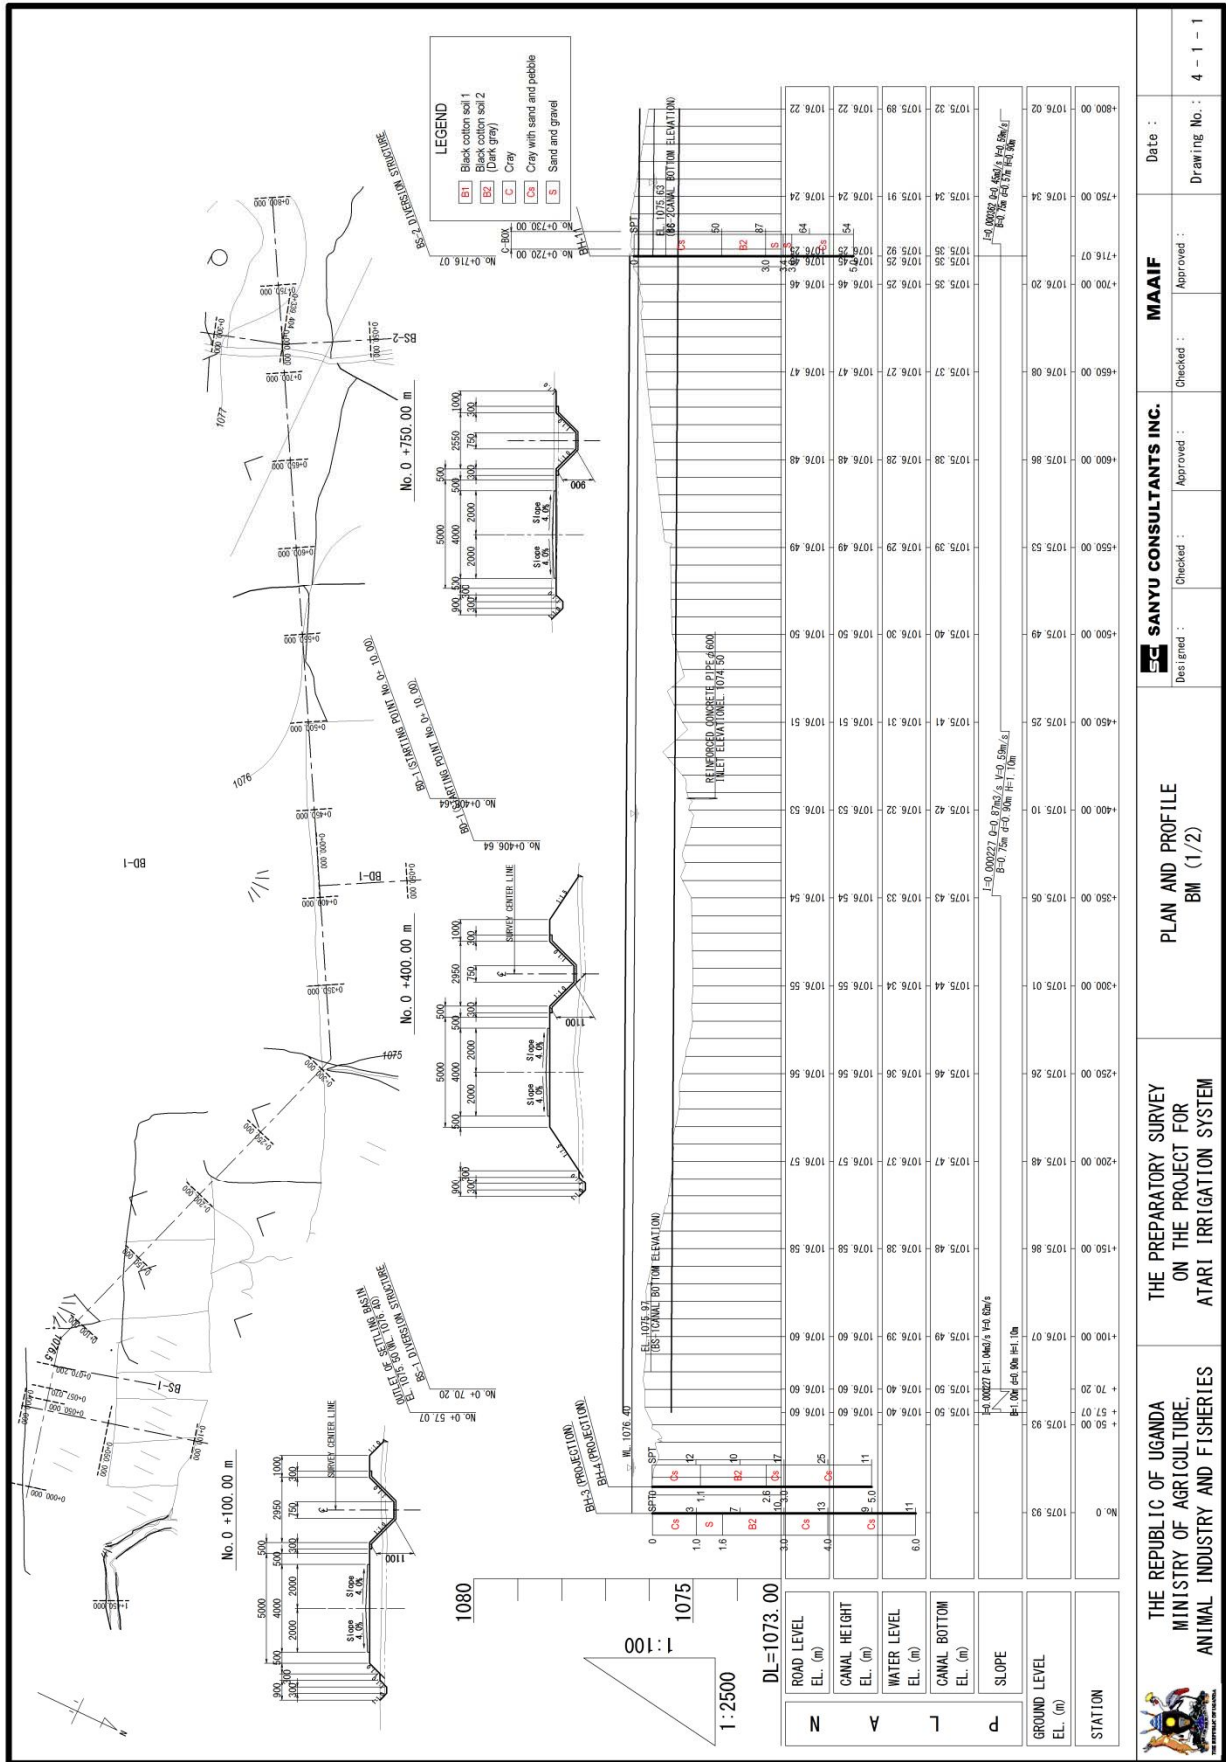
ブランブリ県幹線水路(BM) 縦断面図 (1/2)
